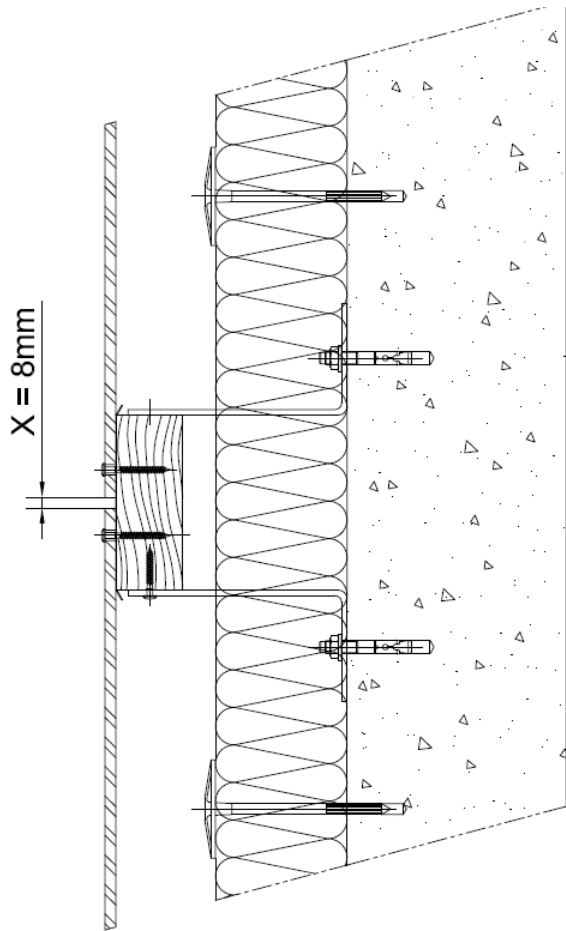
Sección horizontal. Junta vertical entre paneles.
